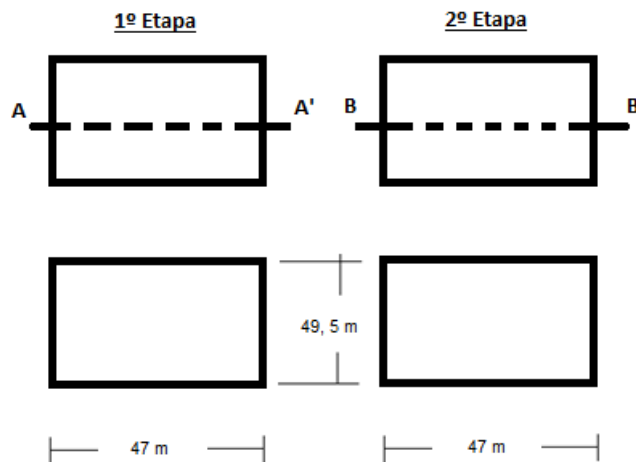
Imágenes que muestra la disposición de las celdas del humedal (no a escala). Fuente propia
